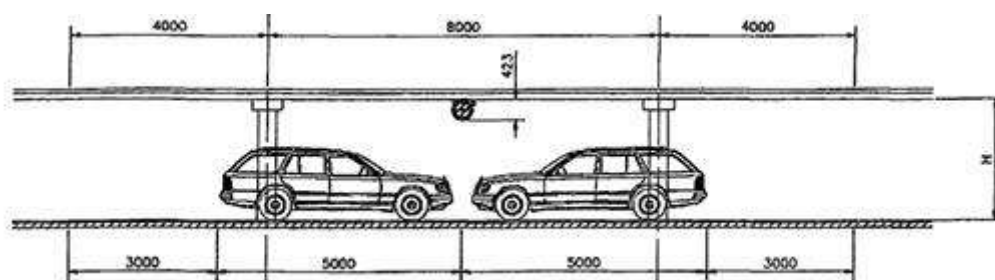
Расположение струйных вентиляторов над парковочными местами
